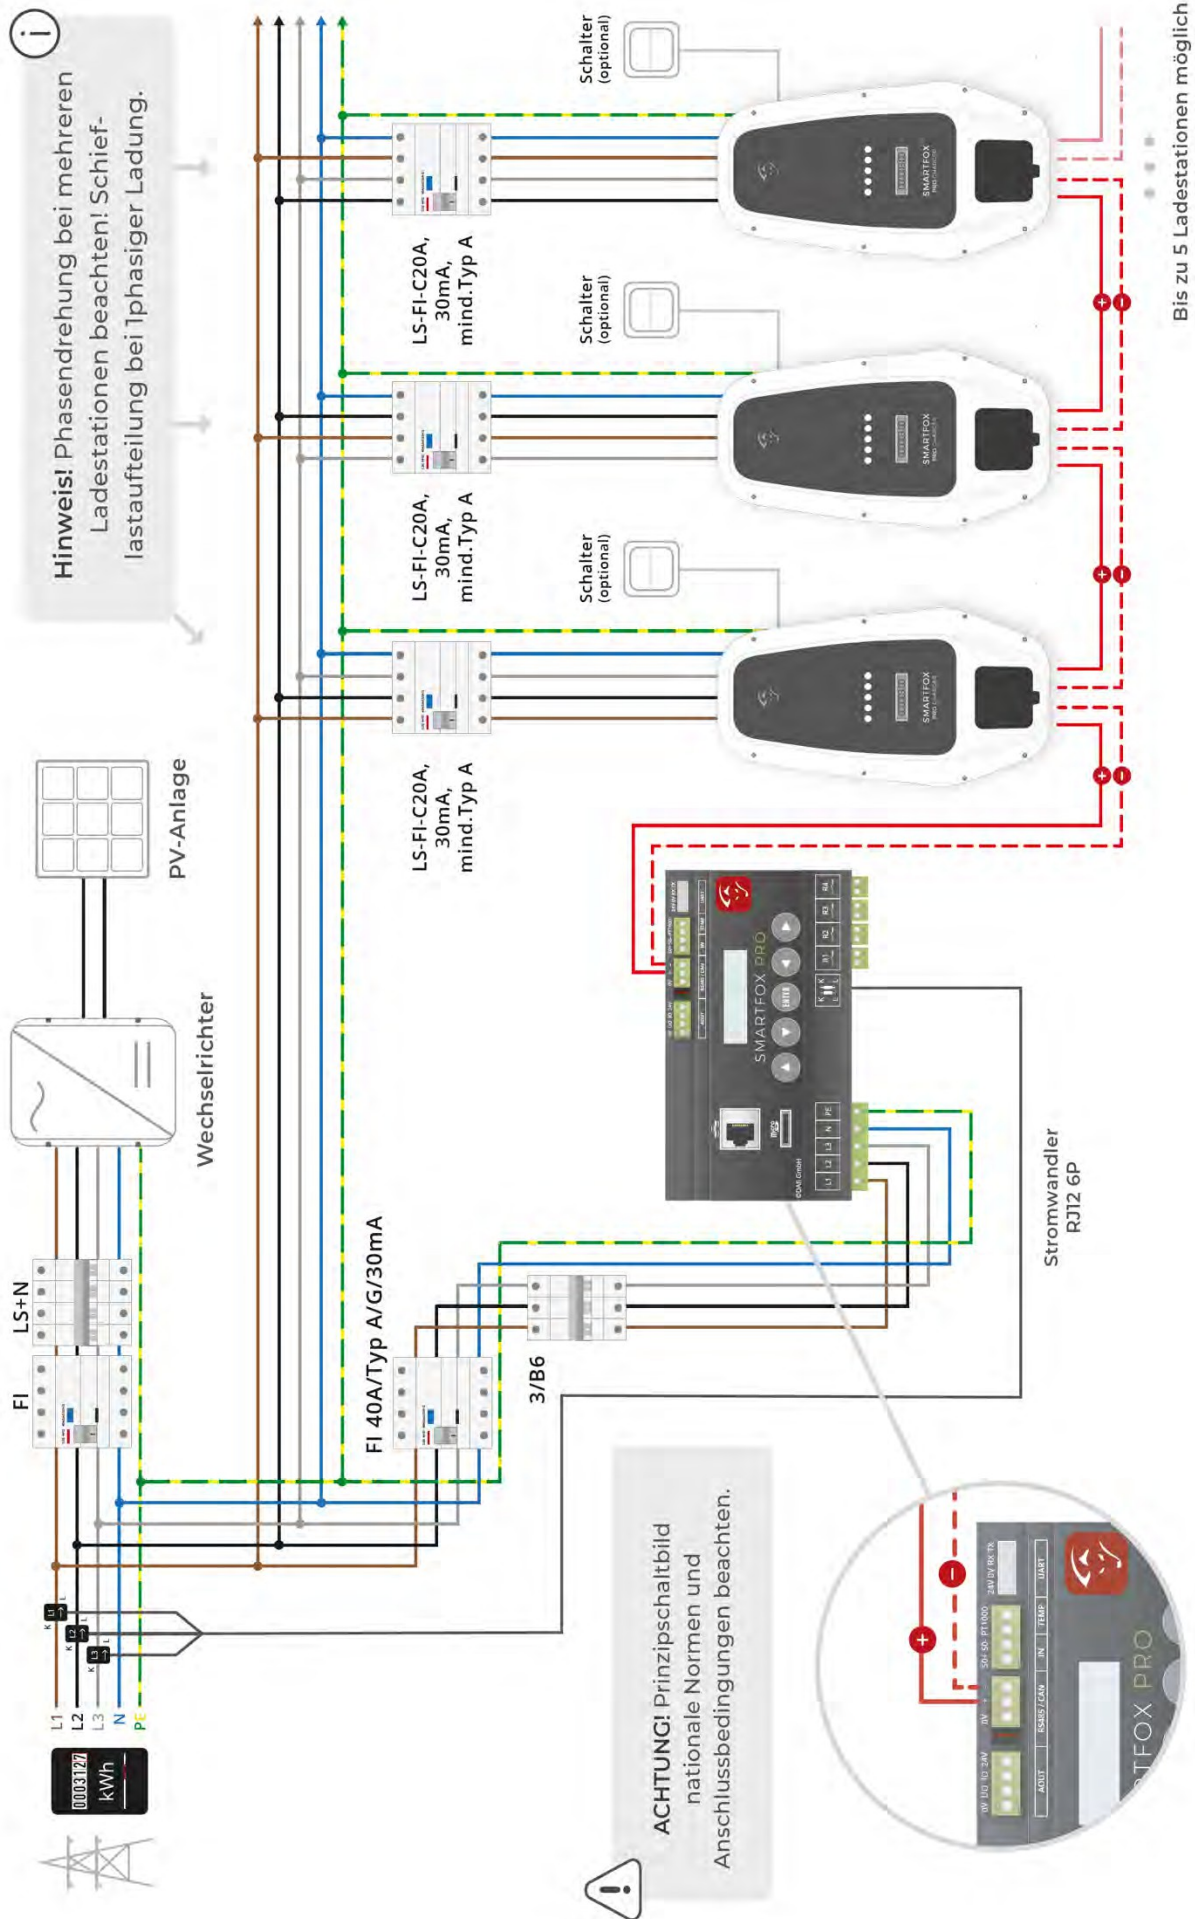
Schema di collegamento con SF Pro - stazioni di ricarica multiple
